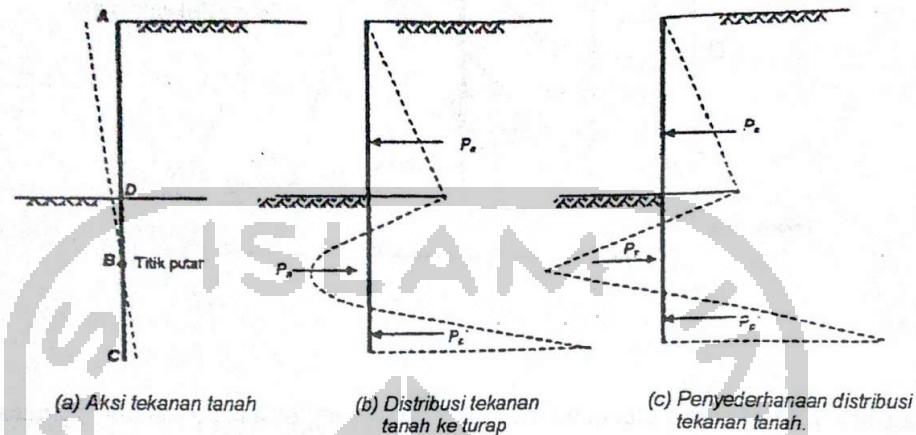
(a) Sheet Pile Dengan Landasan
